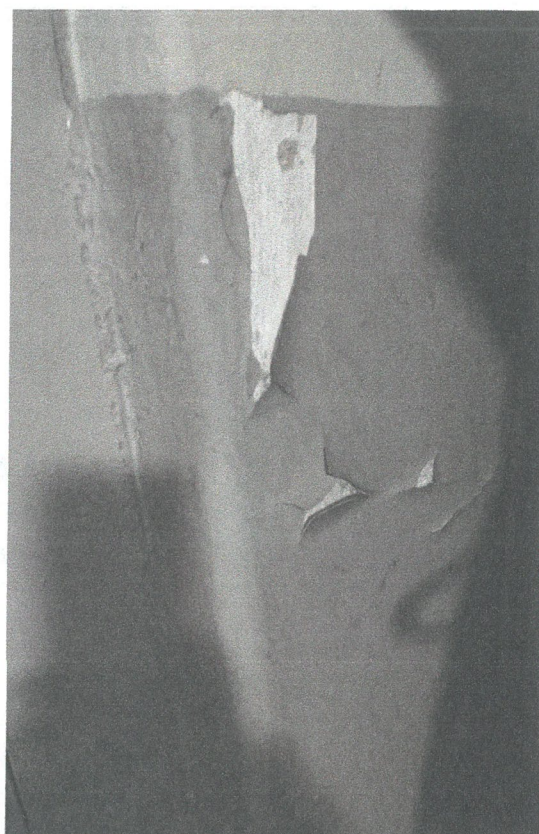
Zakrystia wschodnia – ściana zachodnia - widoczna nowa instalacja.
